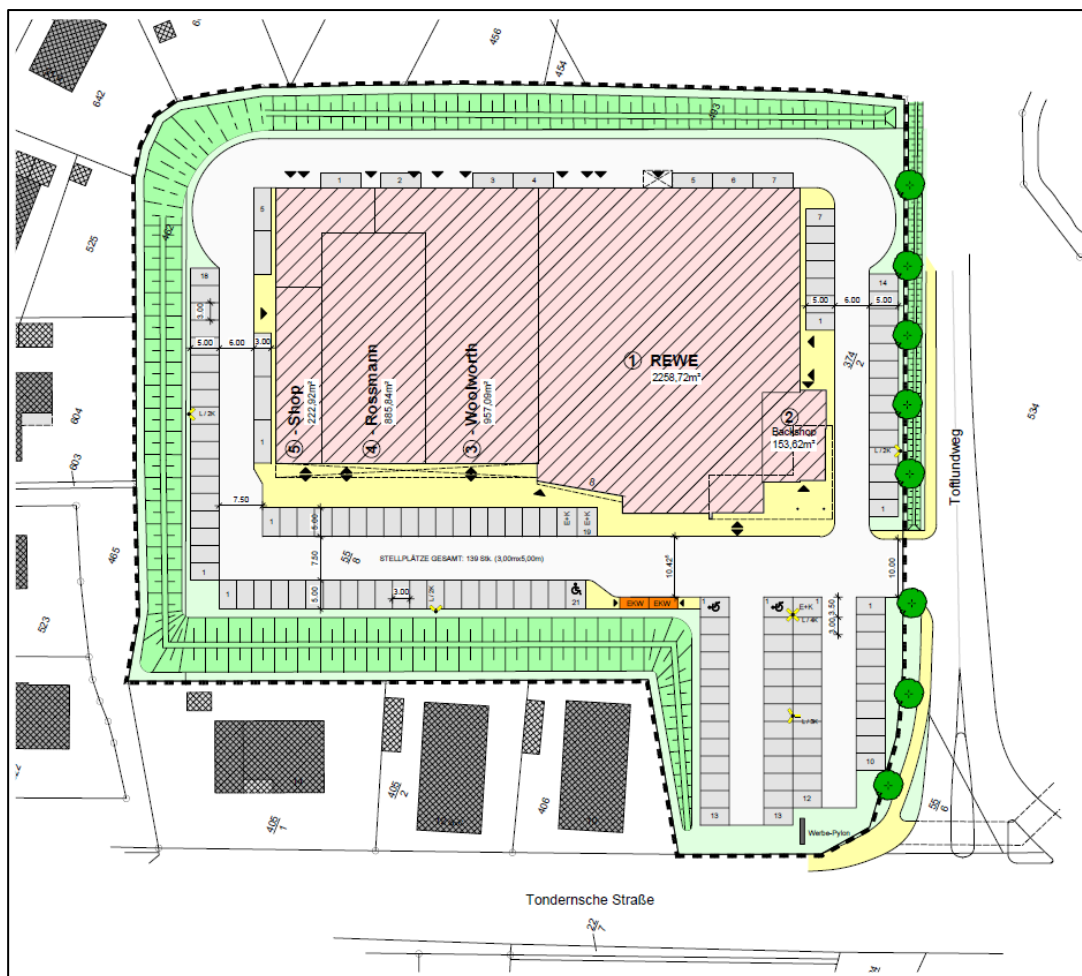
Lageplan des Vorhabengrundstücks¹
